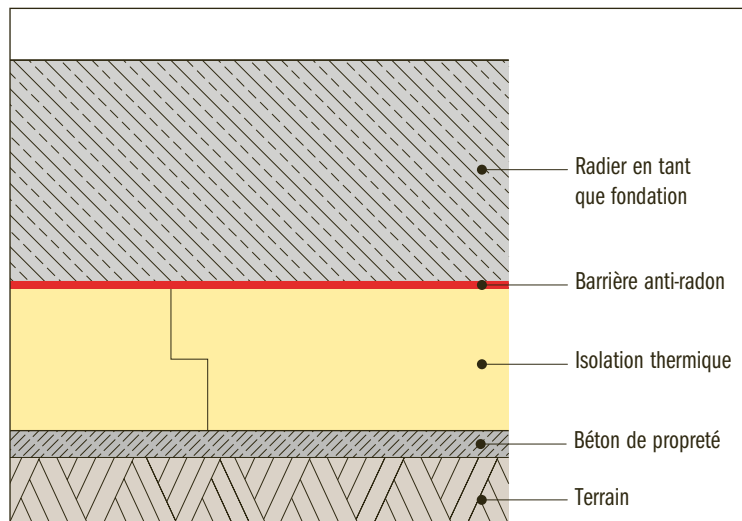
Barrière anti-radon et isolation thermique en dessous de la dalle de fondation (source : Dow Building Solutions).
